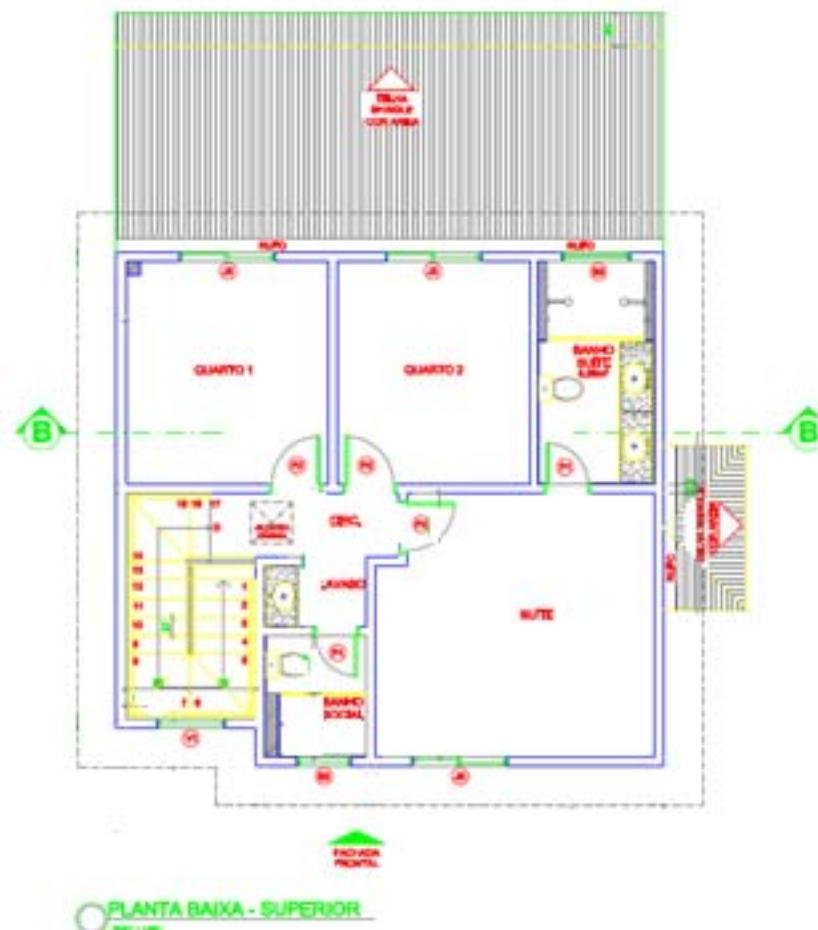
Planta baixa do pavimento superior da Unidade 2
